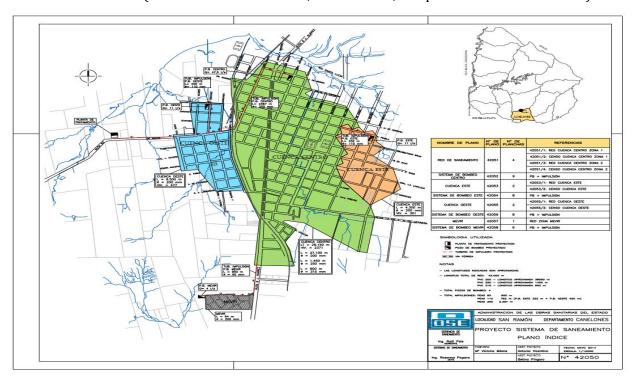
Plano índice del proyecto del sistema de saneamiento de San Ramón
